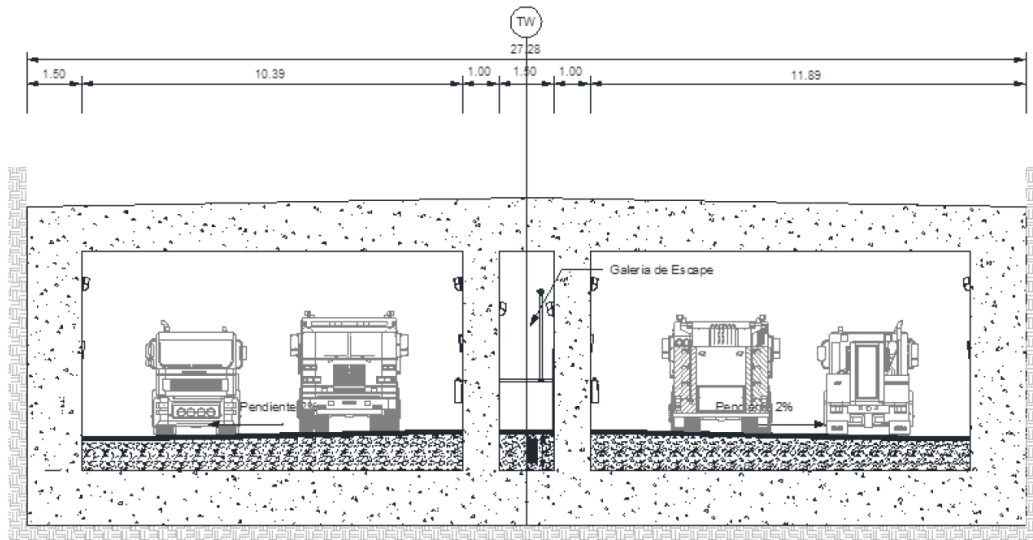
Sección en cajón con galería intermedia, túneles Este (TASANA, 2016)
